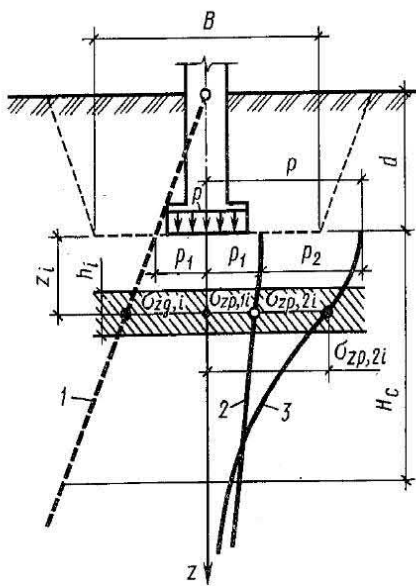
Расчетная схема для определения осадки с учетом разуплотнения грунта при разработке котлована
